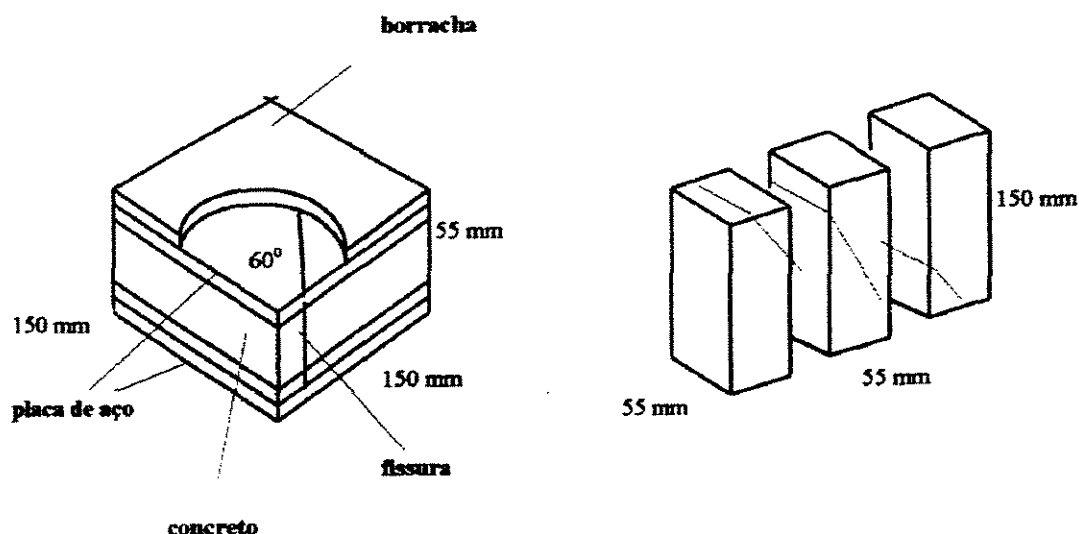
Conjunto para produção de fissuras controladas em placas de concreto e placas cortadas reparadas para obtenção de espécimes de ensaio. TABOR (1978)
